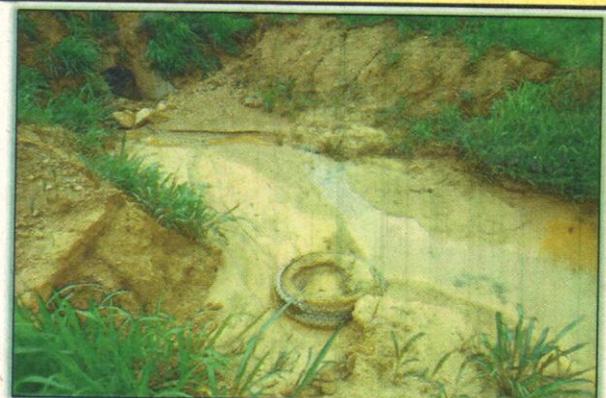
Bueiro Obstruído. Lado Esquerdo.
